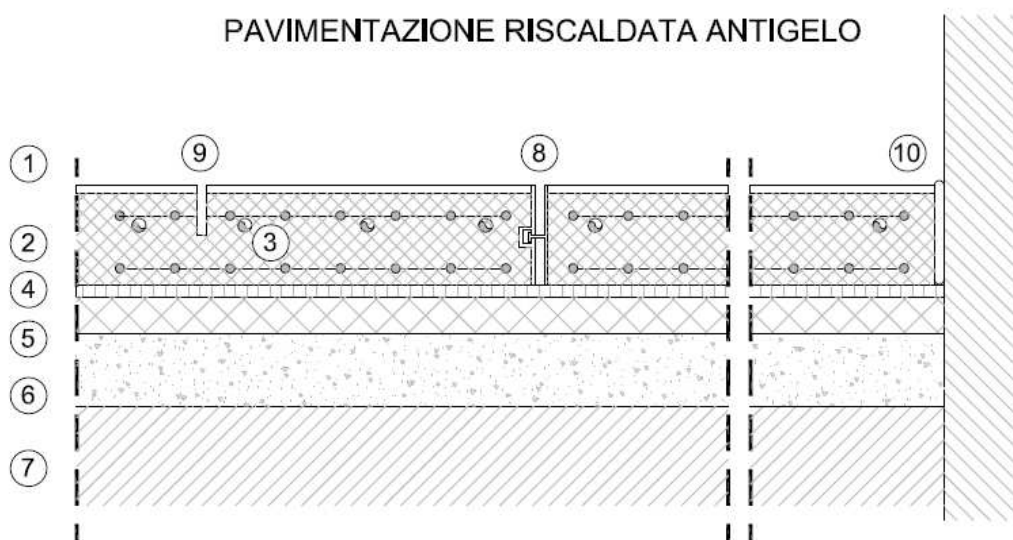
Ipotesi stratigrafiche della pavimentazione dei piazzali di volo
